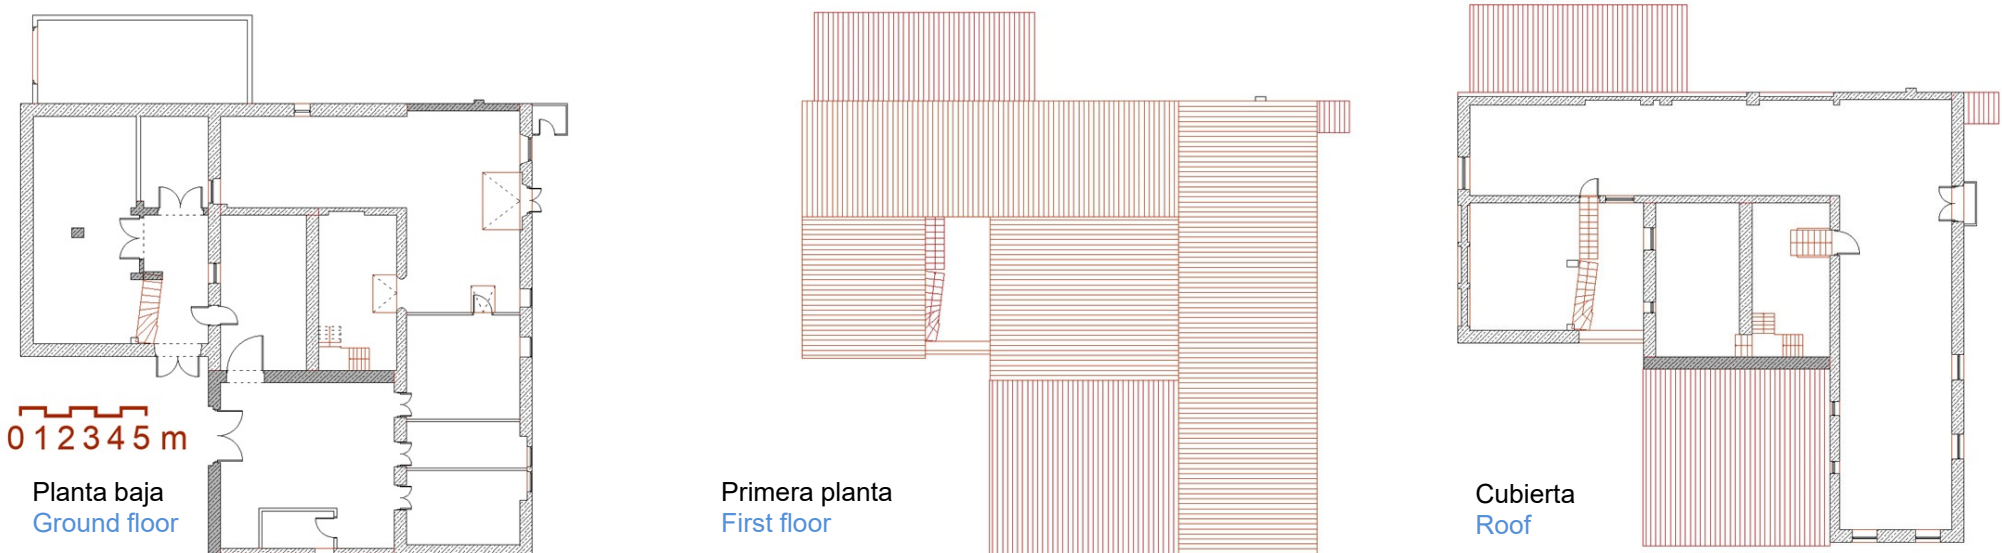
Plantas / Image 2. Floor Plans © I. Álvarez
